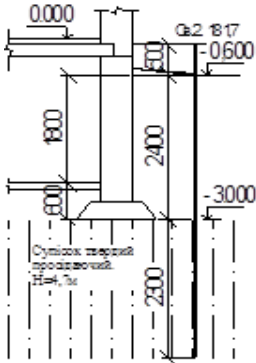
Вертикальна прив'язка фундаменту по осі 8.
